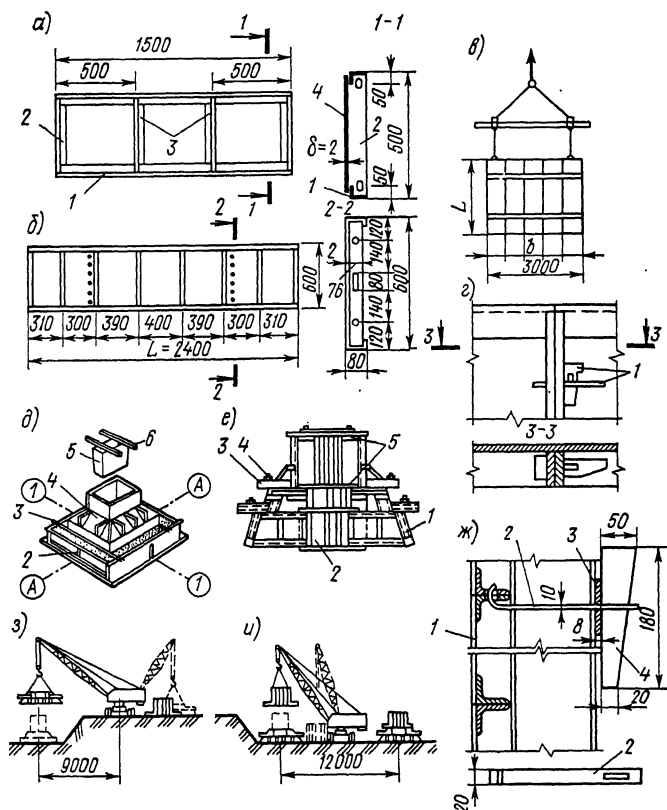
Технология монтажа блочной металлической опалубки для устройства монолитных фундаментов и стен
